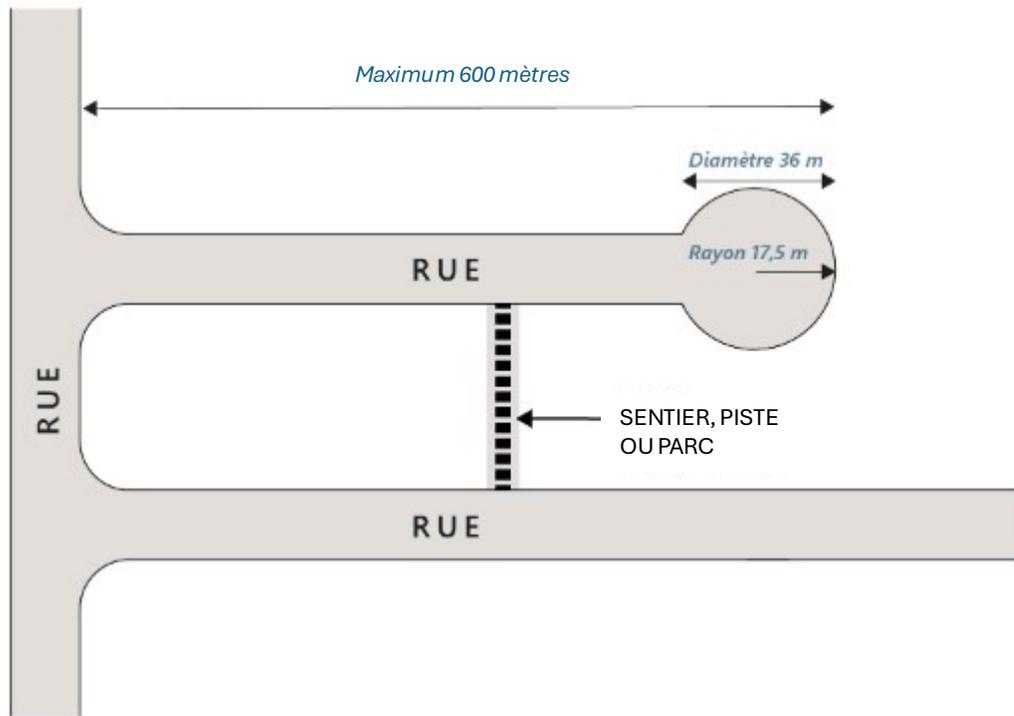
Rue en cul-de-sac avec un sentier ou piste
